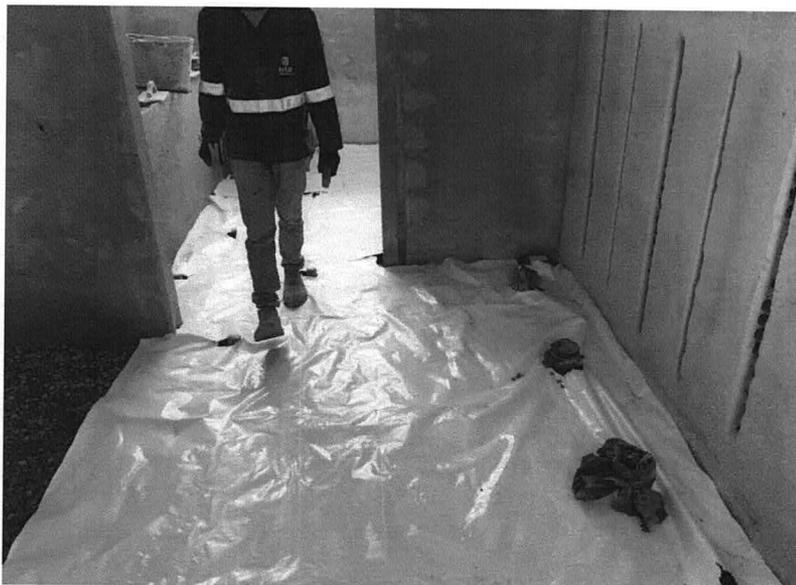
Aplicação de lona para impermeabilização e execução do contrapiso impermeabilizado
